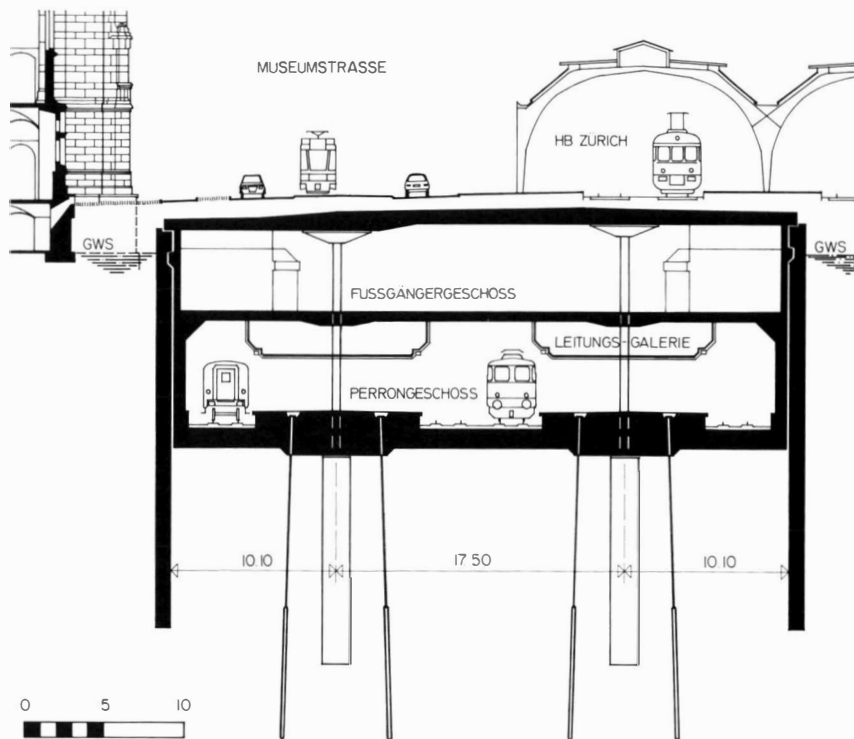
Querschnitt – Coupe en travers – Cross-section
